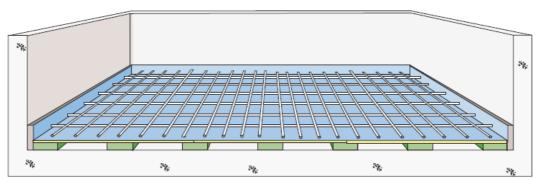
Installation des armatures de la dalle flottante (si nécessaire) sur les panneaux de coffrage en respectant le bon enrobage.
